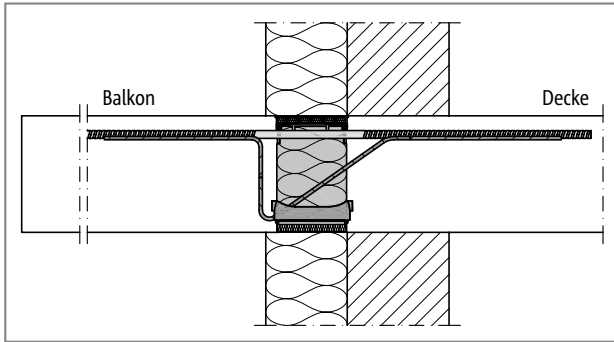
Schöck Isokorb® CXT Typ K: Anschluss bei Wärmedämmverbundsystem (WDVS)
